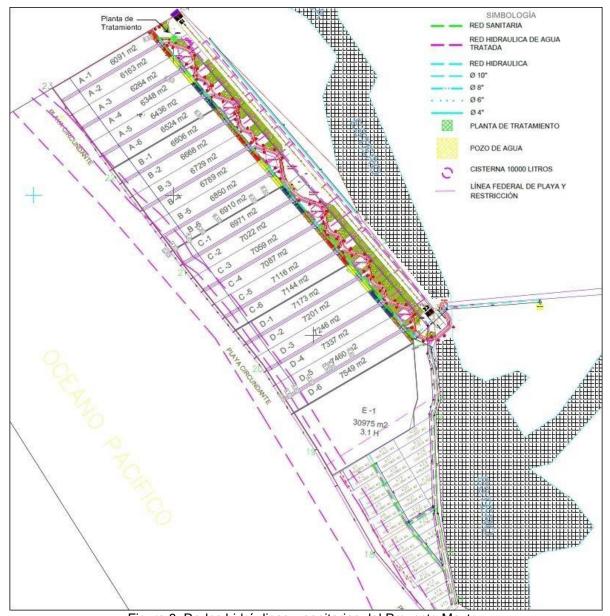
Redes hidráulicas y sanitarias del Proyecto Mayto. Se adjuntan Planos Hidráulicos y Sanitarios del Proyecto en la sección de Anexos.
